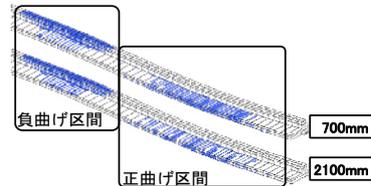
ひび割れ図(最大正曲げ時)²⁾
